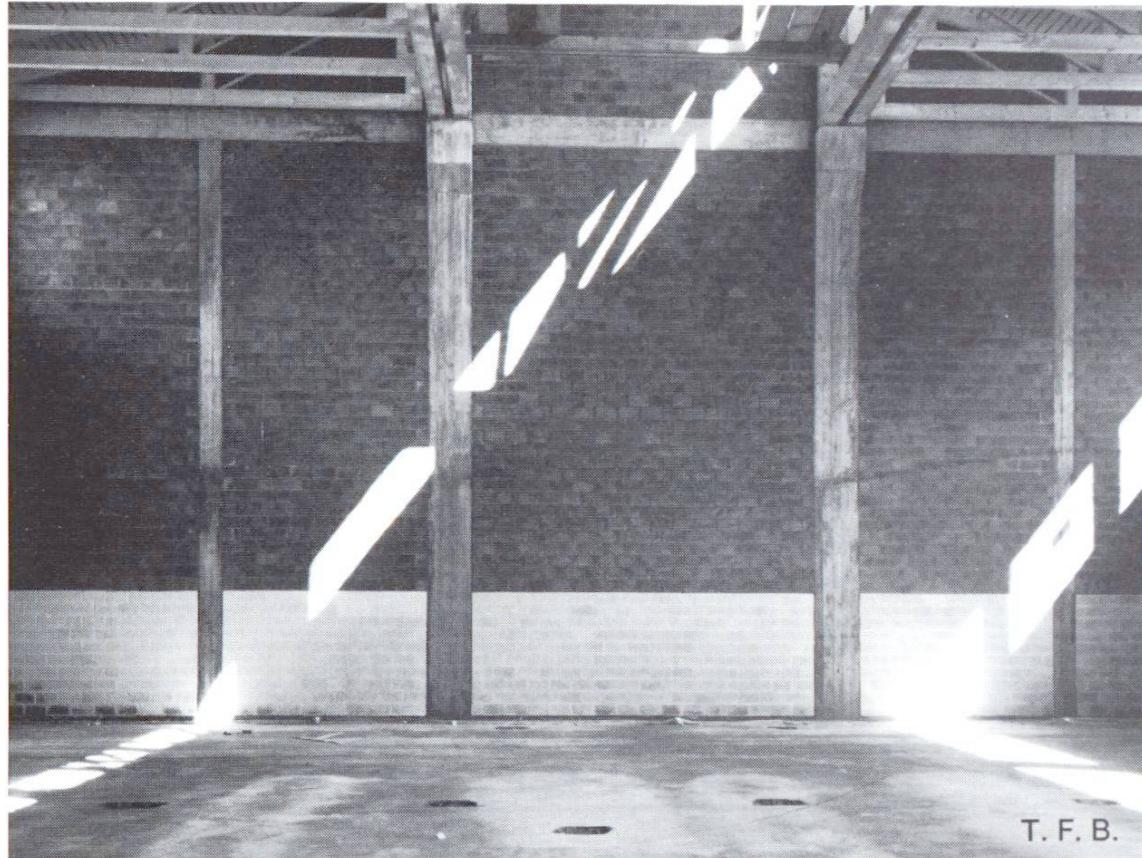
Beton-Sichtmauerwerk in einem Industriebau.
